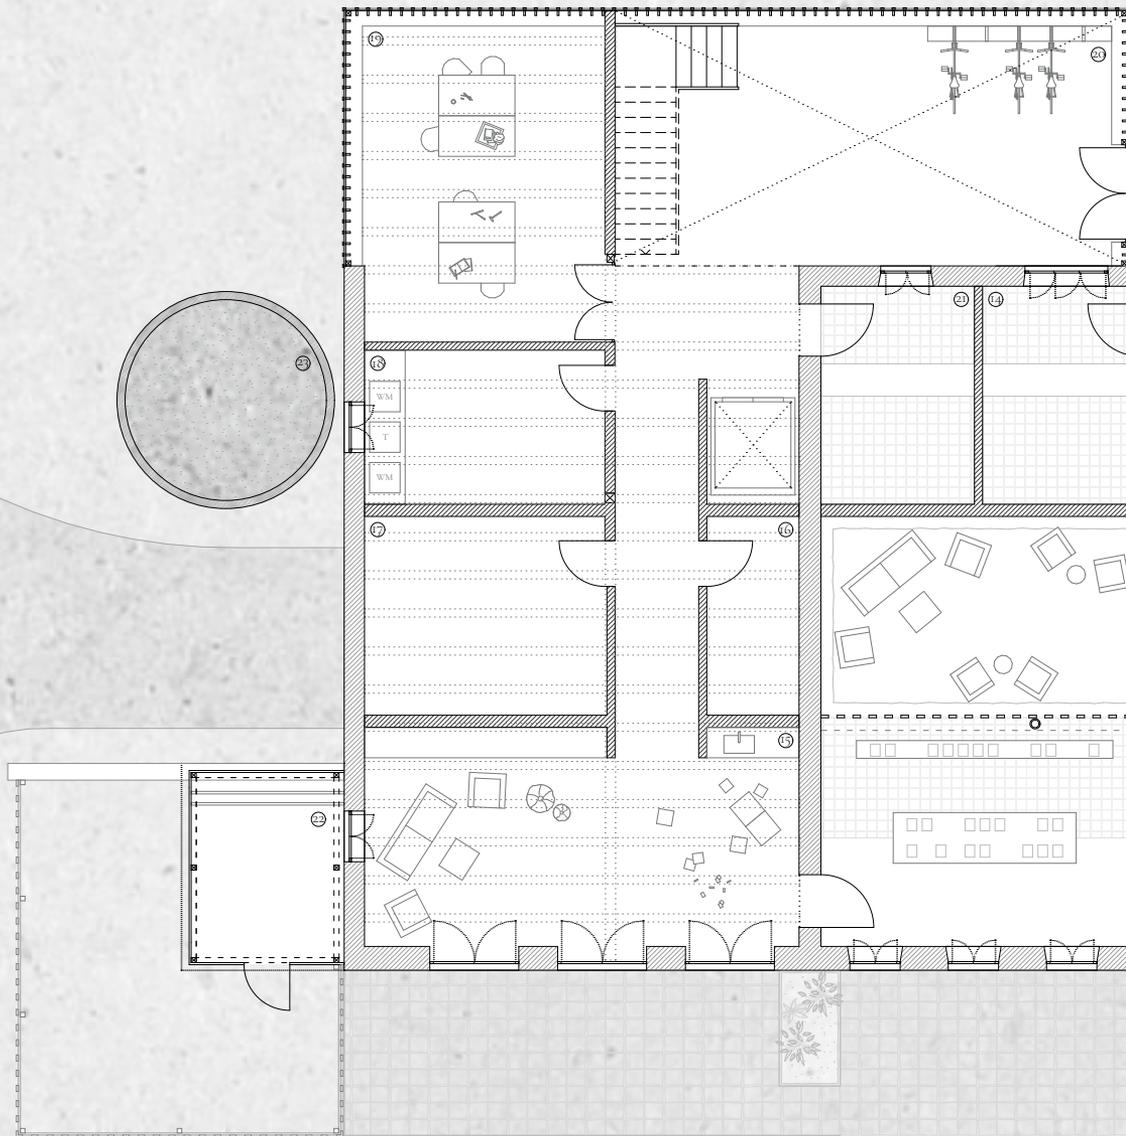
Grundriss Erdgeschoss, M 1_200
